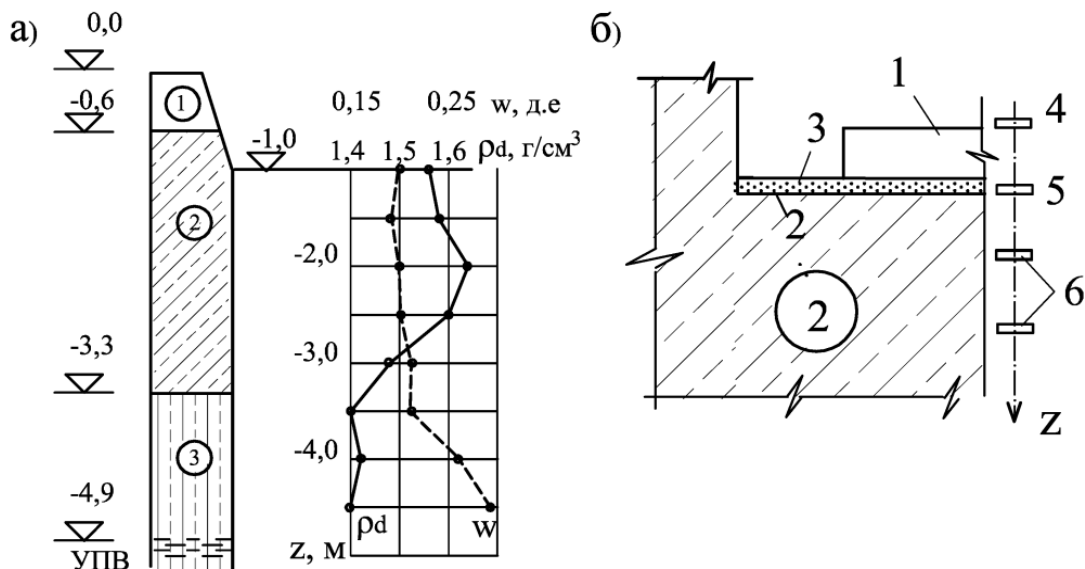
Геологическое строение участка и схема подготовки основания опытных фундаментов к испытаниям: 1 – опытный фундамент; 2 – поверхность грунта основания; 3 – песчаная подготовка; 4 – магнитная марка в фундаменте; 5 – контактная
